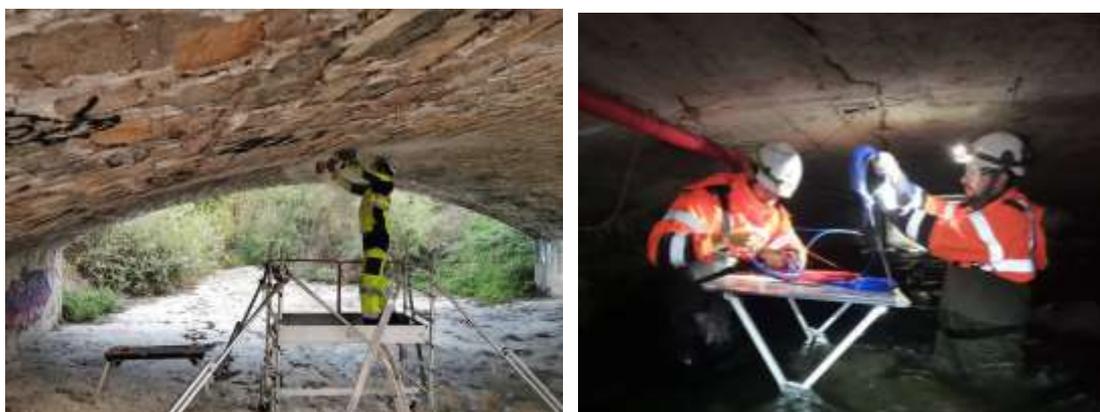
Travaux d'installation des capteurs sur ouvrage
